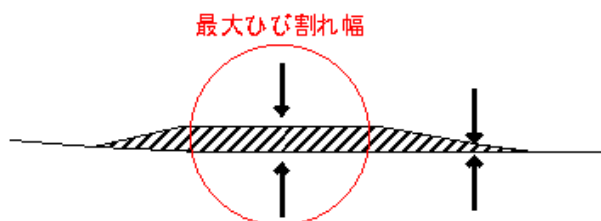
1本のひび割れにおける最大ひび割れ幅計測位置
